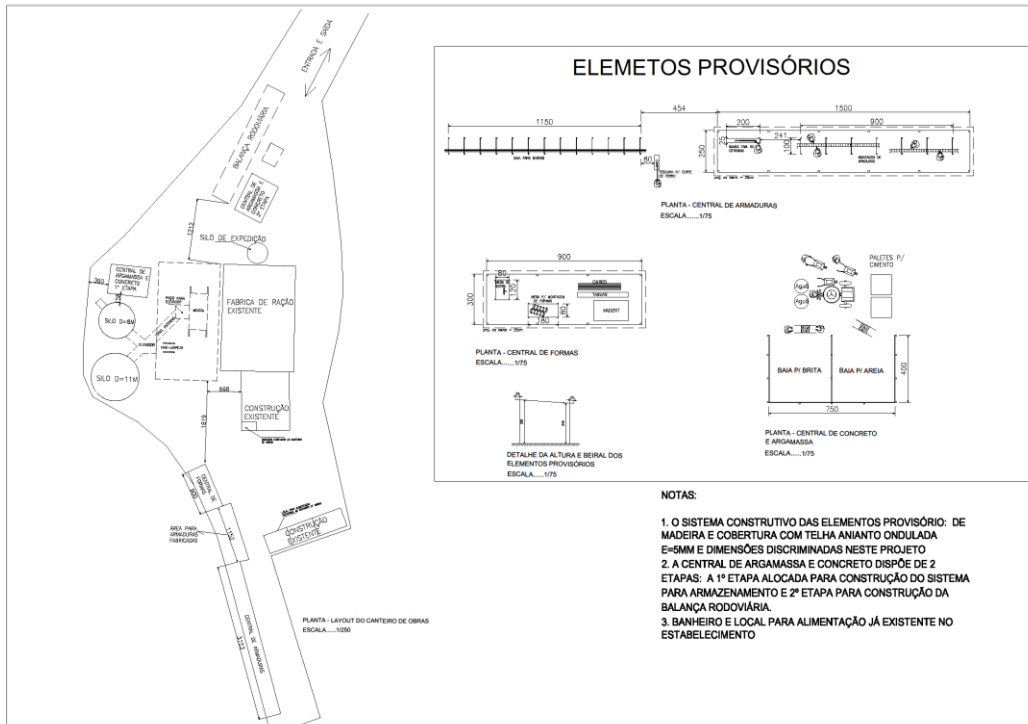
Localização do canteiro de obras - Fazenda Várzea do Pau D'algo
